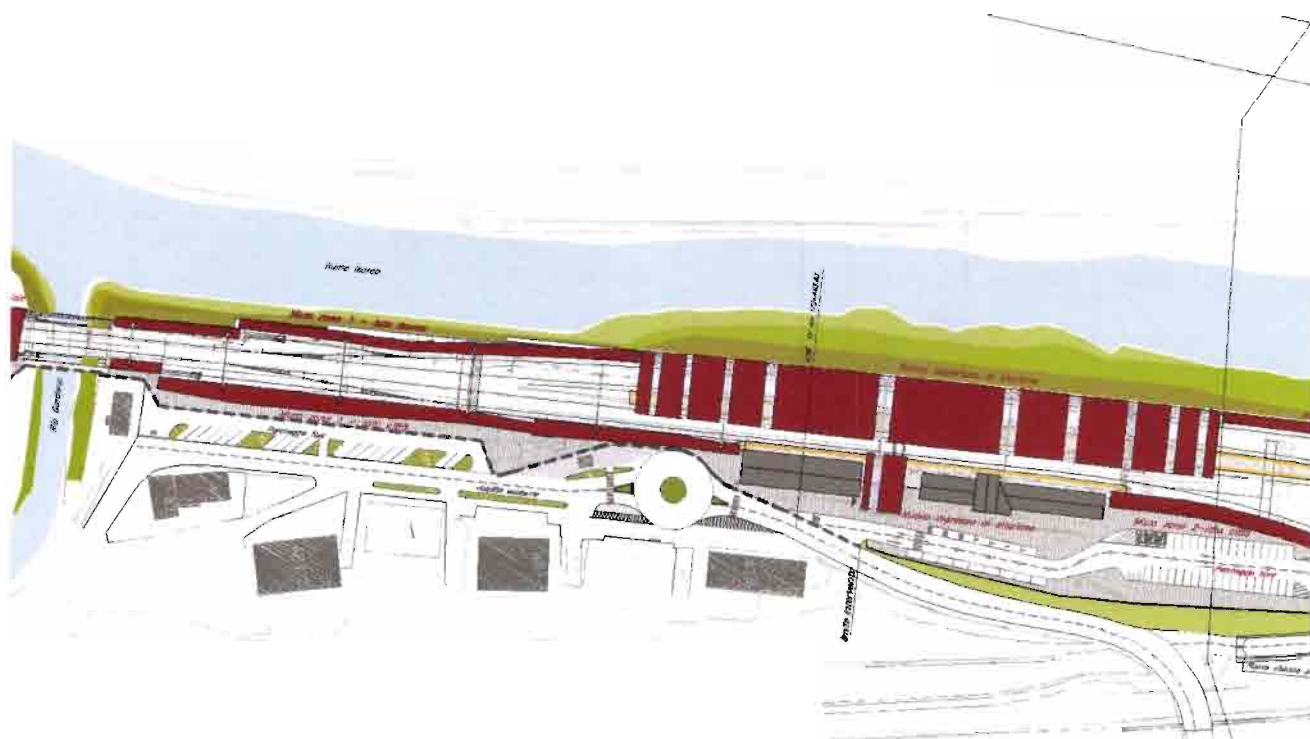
Muri zona 1 lato Isarco: stralcio planimetrico
